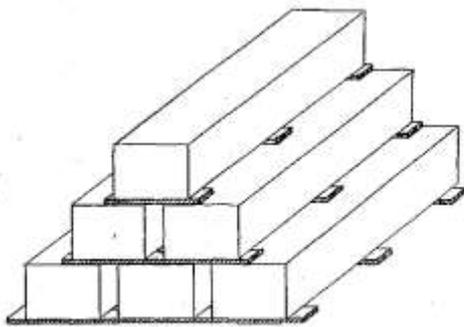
Схема складирование штабеля из отдельных грузовых мест и пакетов
